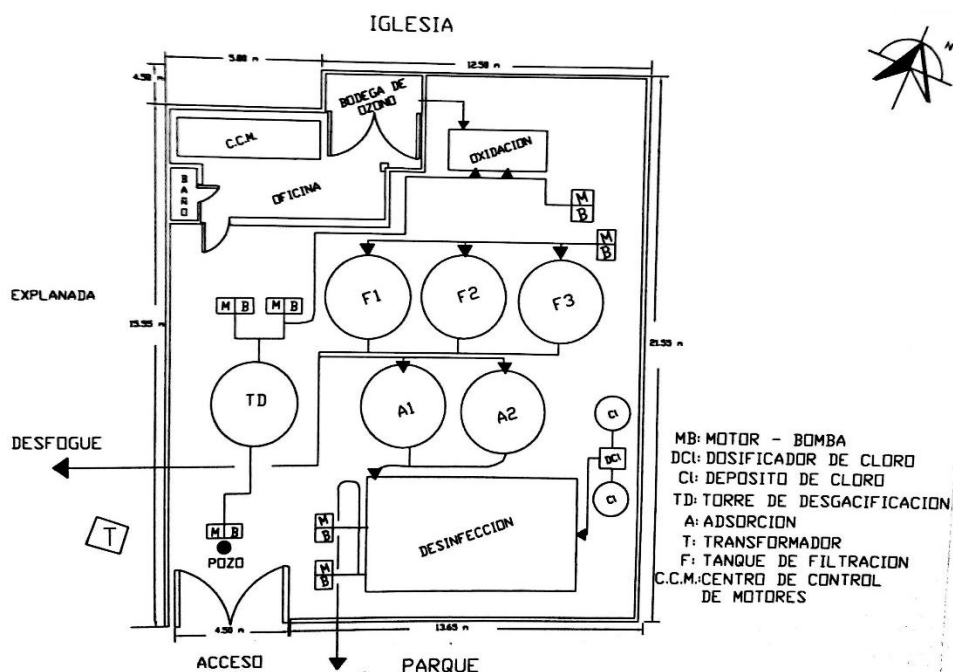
Vista en planta de la PP Iztapalapa 1
